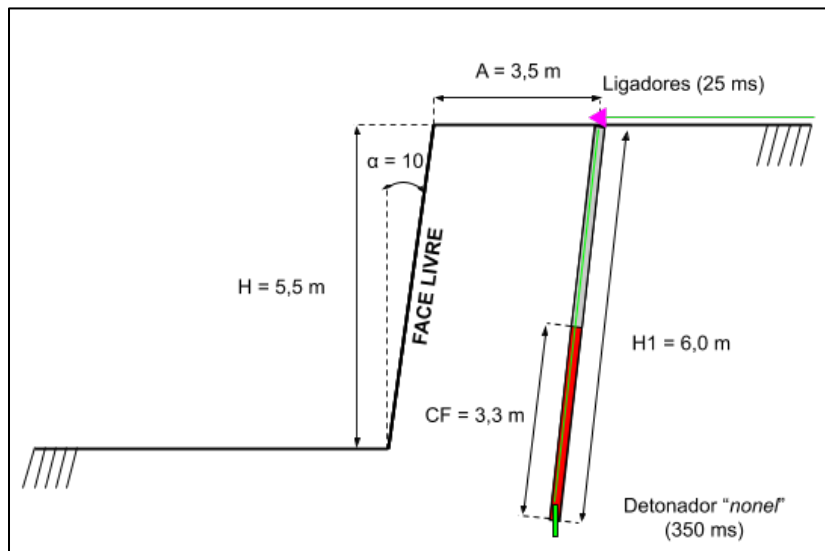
Esquema da detonação por NITRAM 5 com afastamento de 3,5 m e diâmetro de furo de 89 mm
